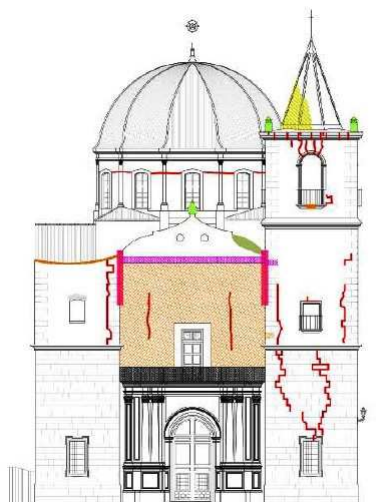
Alzado de la iglesia de San Mateo donde se aprecia la grieta horizontal del tambor de la cúpula
